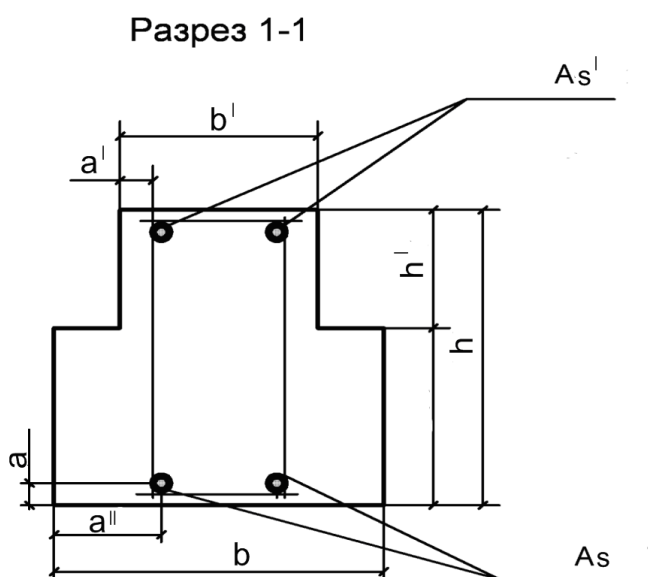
Сечение железобетонного ригеля: b – ширина нижнего ребра таврового сечения; b' – ширина верхнего ребра таврового сечения; h – толщина ригеля; h' расстояние от полки ригеля до верхнего ребра; A_s – суммарное сечение нижней арматуры; A_s' – суммарное сечение верхней арматуры; a , a' , a'' – толщина защитного слоя бетона в разных участках ригеля
